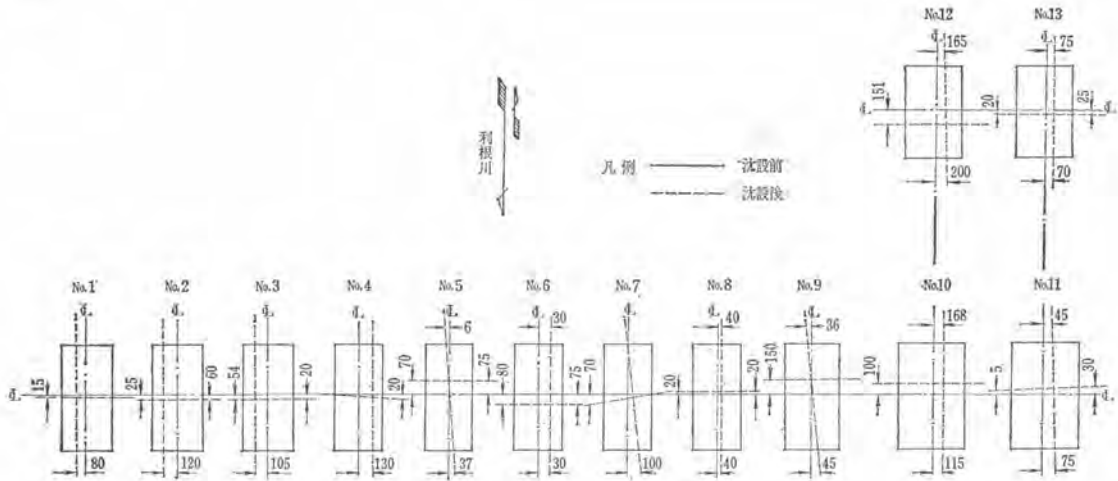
ケーソン沈設平面位置の移動結果 (単位: mm)
